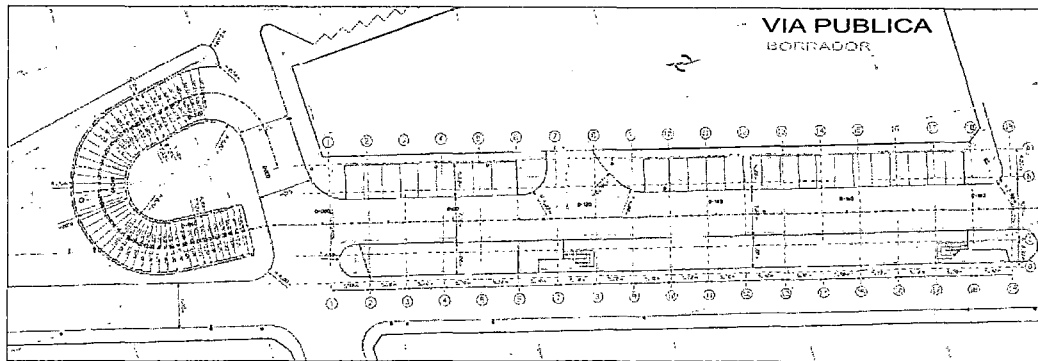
"Vista en planta de diseño preliminar del proyecto" (Barriga Dall' Orto S.A.)
